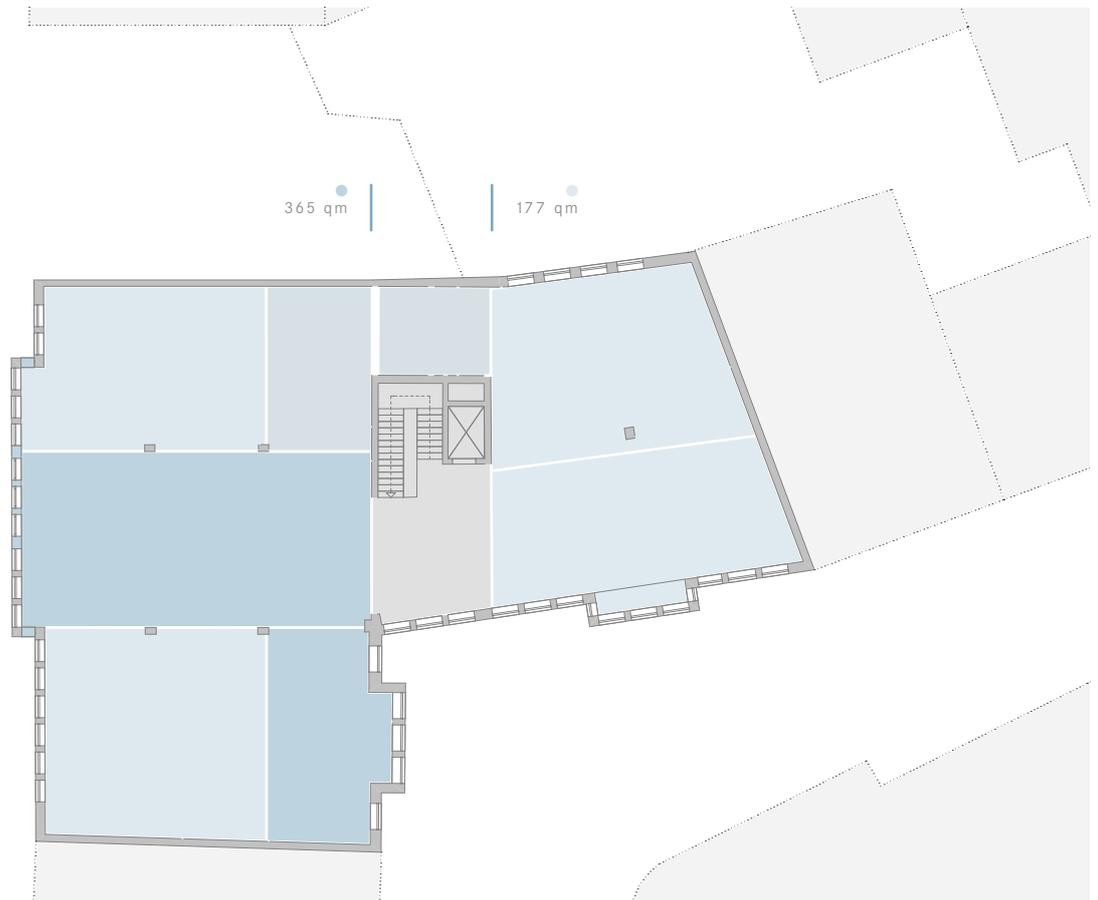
Grundriss Umbau - Nutzungseinheiten
